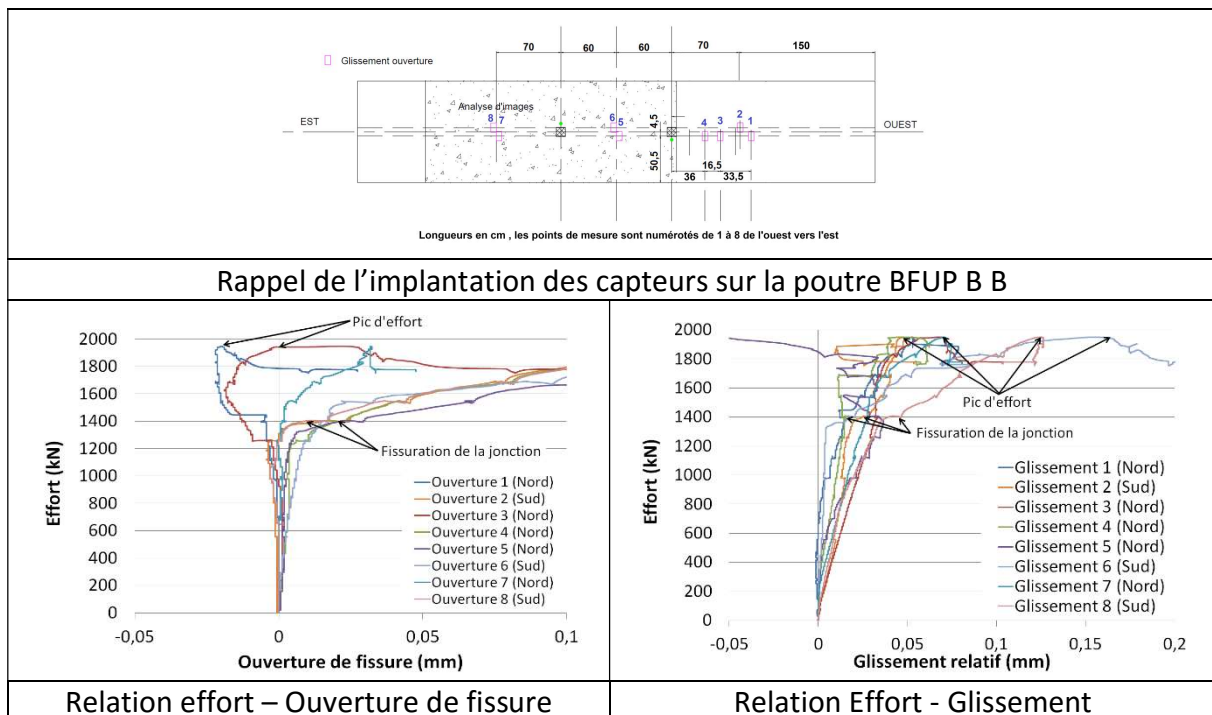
Evolution de la fissuration au droit de la jonction, poutre BFUP B B
